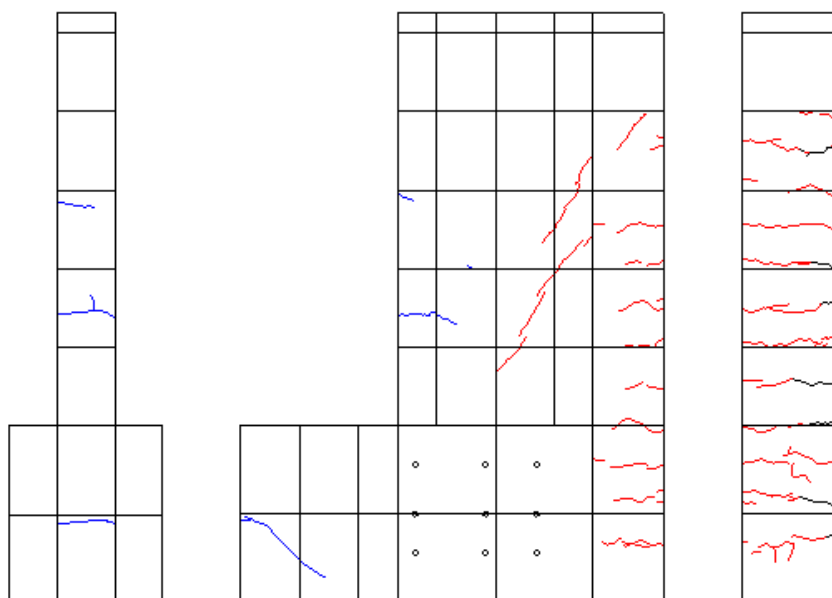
R=1/200 ひび割れ図
